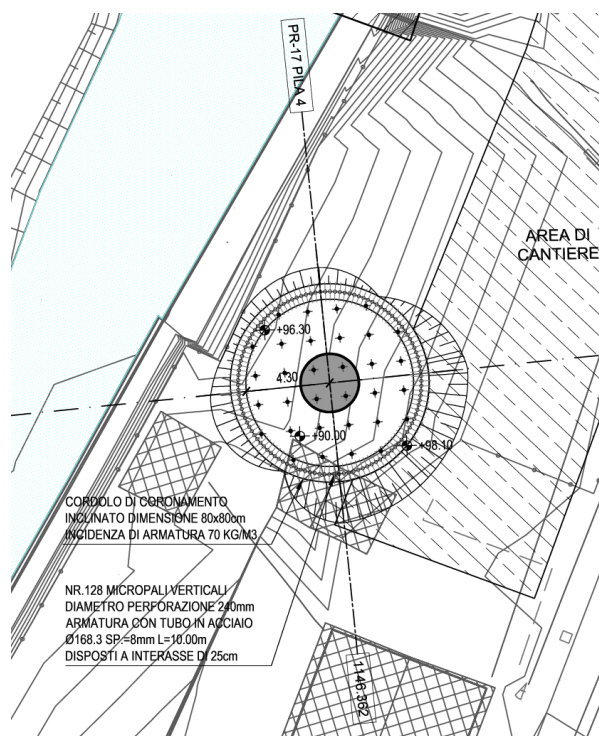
Stralcio planimetrico opera provvisoria pila 4.
